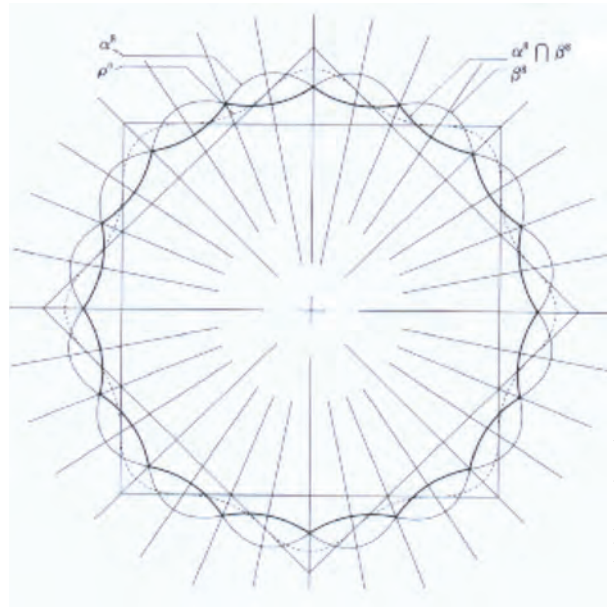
Secció de la columna de la nau central a 8 m d'altura.
